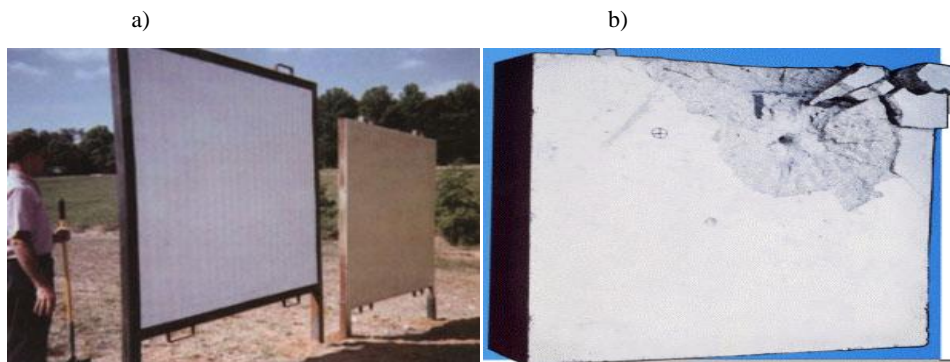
Полигонный стенд для исследования бетонных пластин на сквозной прокол снарядами [316]: а – вид исследовательского стенда, б – характер разрушения бетонной перегородки
